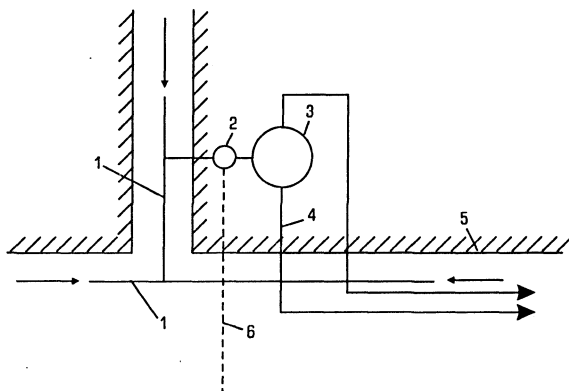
Схема расположения насосной станции и трубопроводов:
